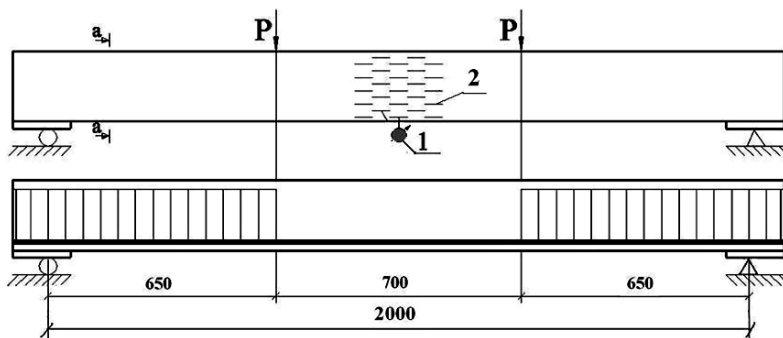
Схема испытания железобетонных балок: 1 – индикатор часового типа, 2 – тензорезисторы.
